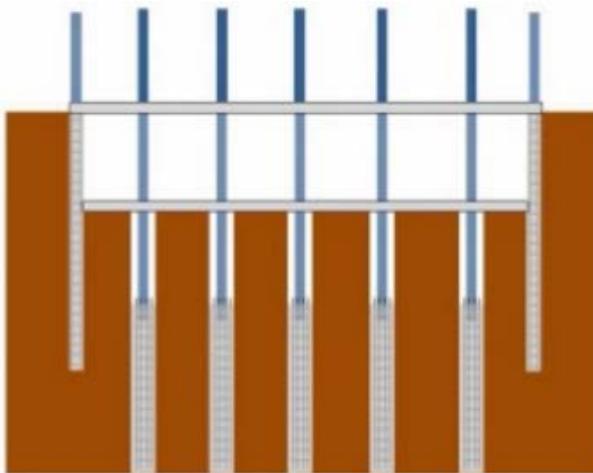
69 Pemasangan Pondasi beserta *King Post
